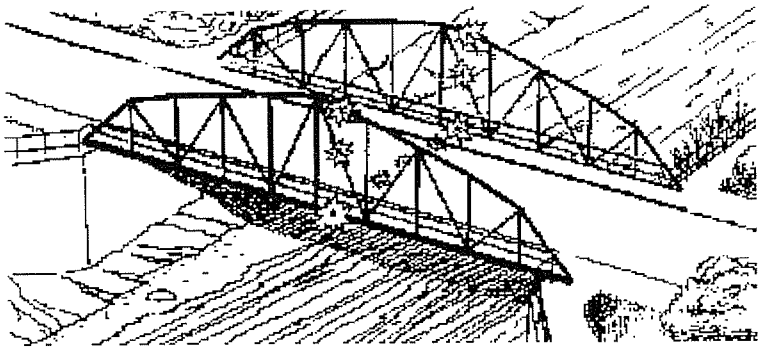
Destrucción de un puente de tramo simple con estructura de viga de celosía
